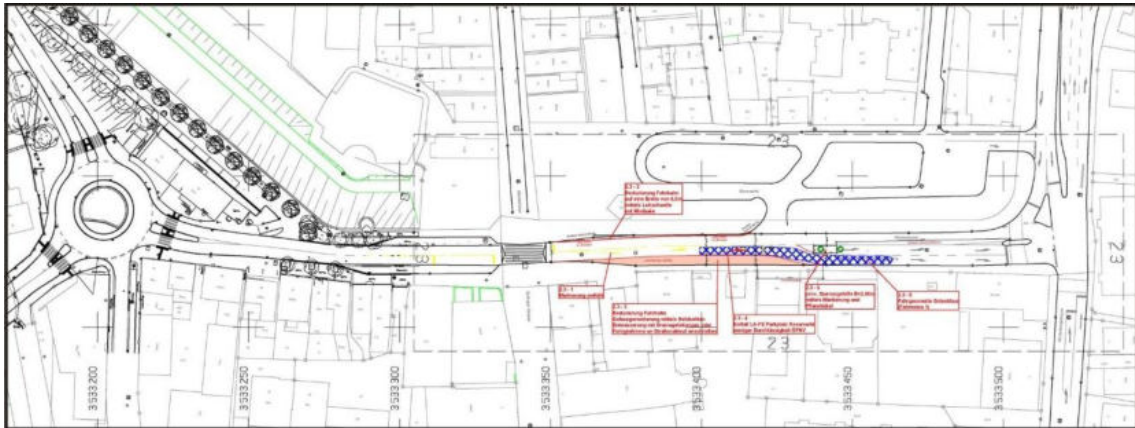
Vorplanung Alleenstraße (Jahnstraße – Hindenburgstraße) [Quelle: SW INGENIEURE]
